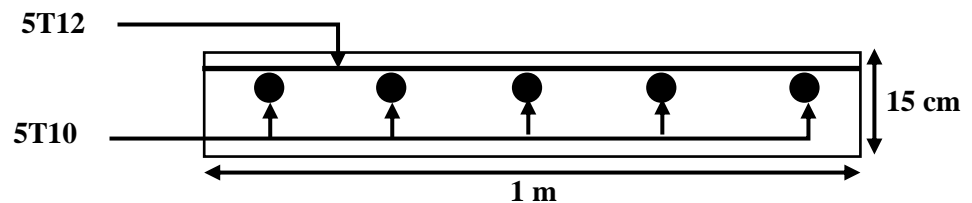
Schéma de ferrailage de balcon type 1.
